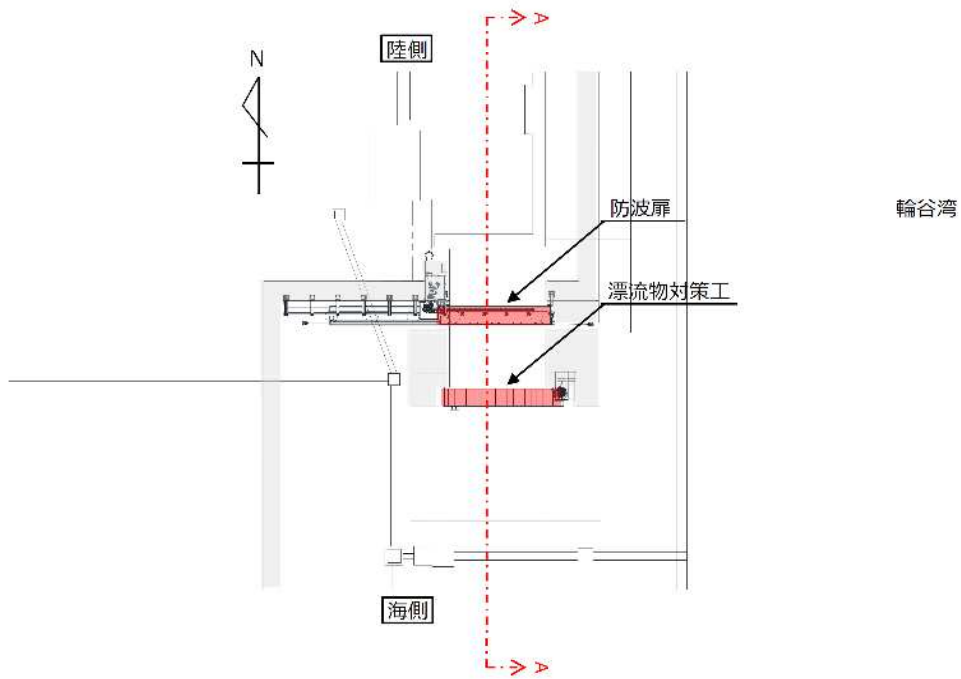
(1) 防波壁通路防波扉（3号機東側） 平面図
